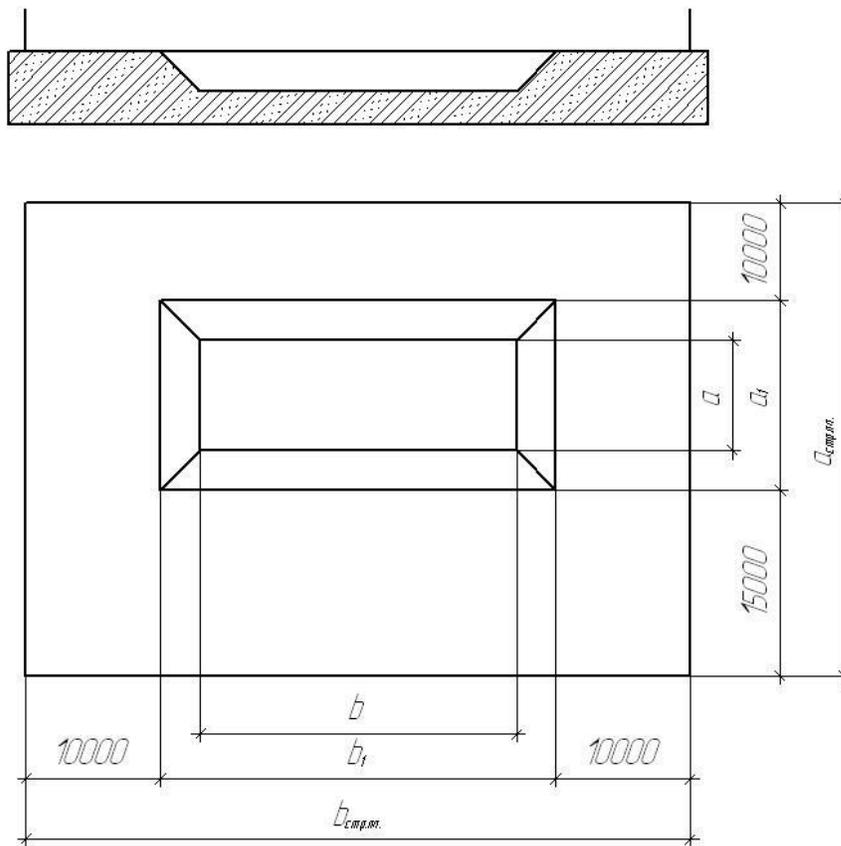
Схема к расчету размеров строительной площадки
